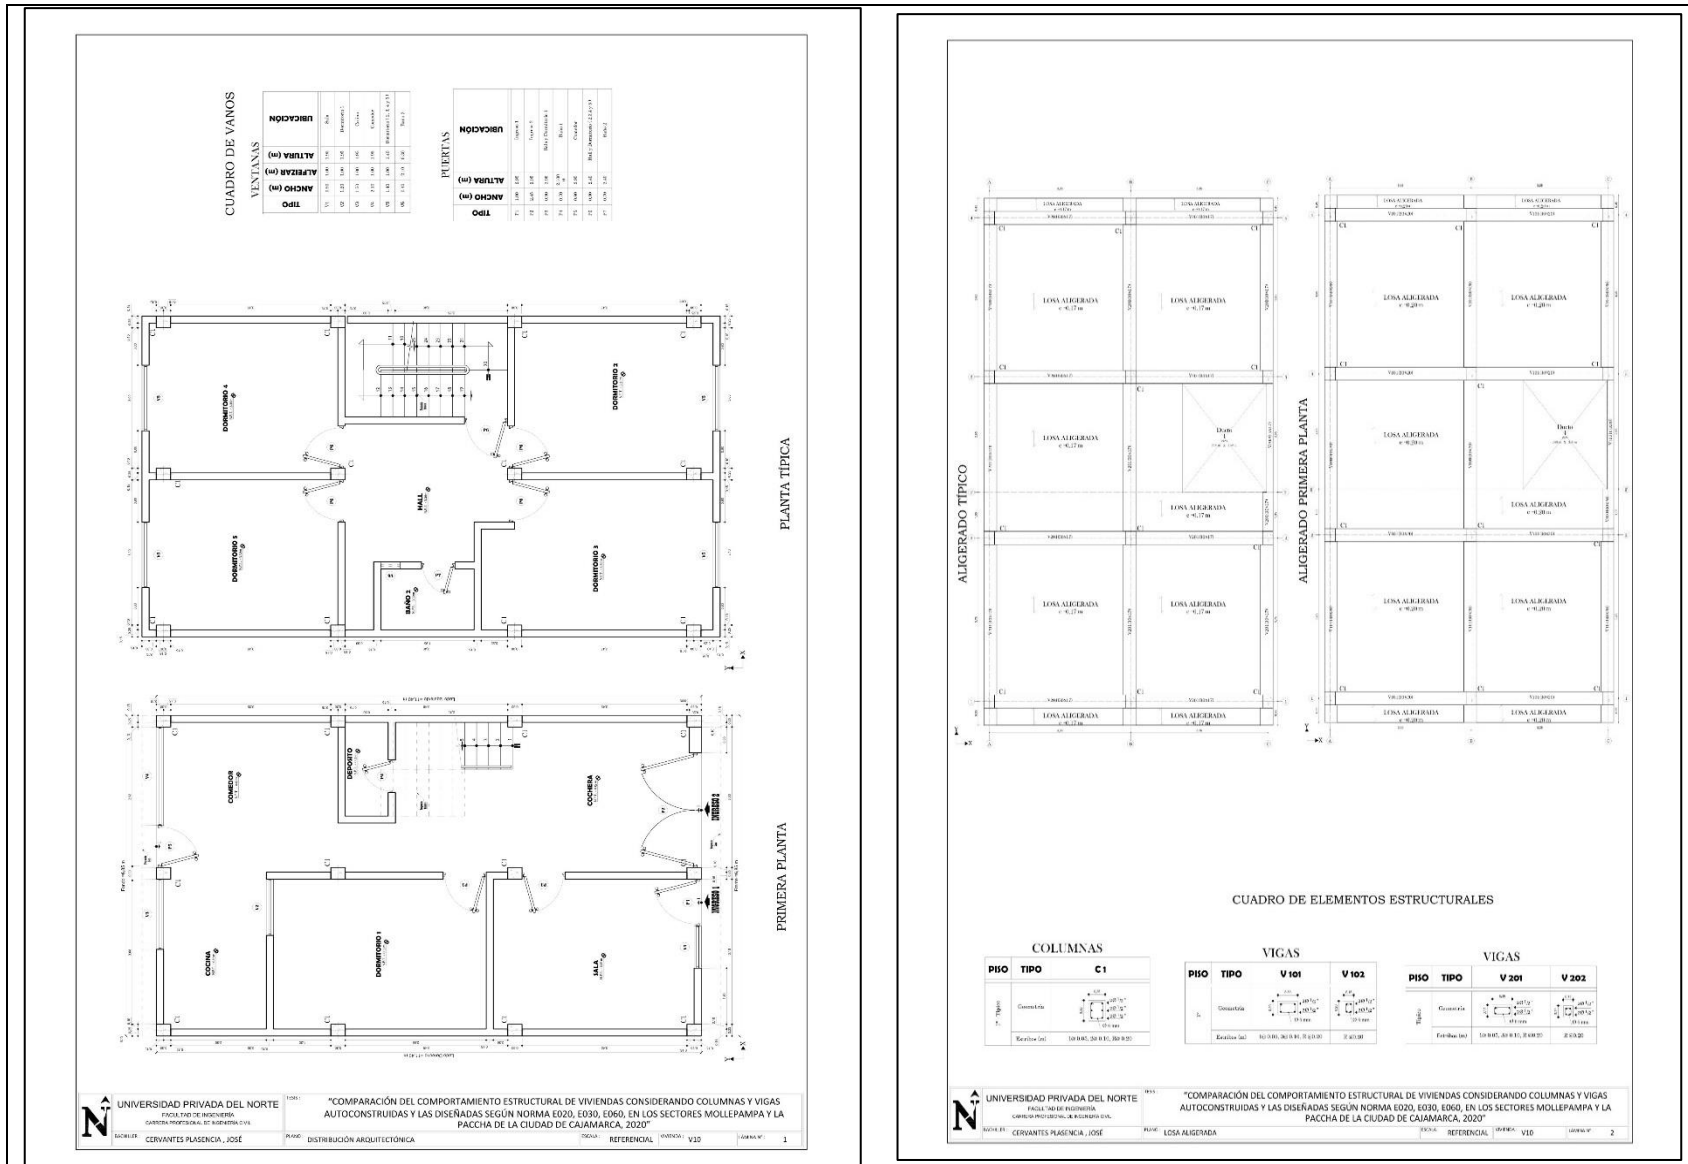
Planos de arquitectura y losa aligerada vivienda 10
